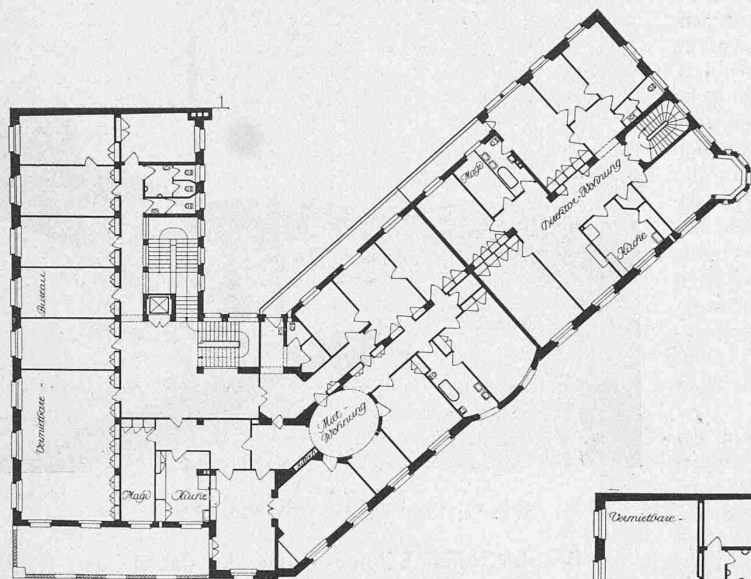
Grundriss vom II. Stock. — Masstab 1:500.
